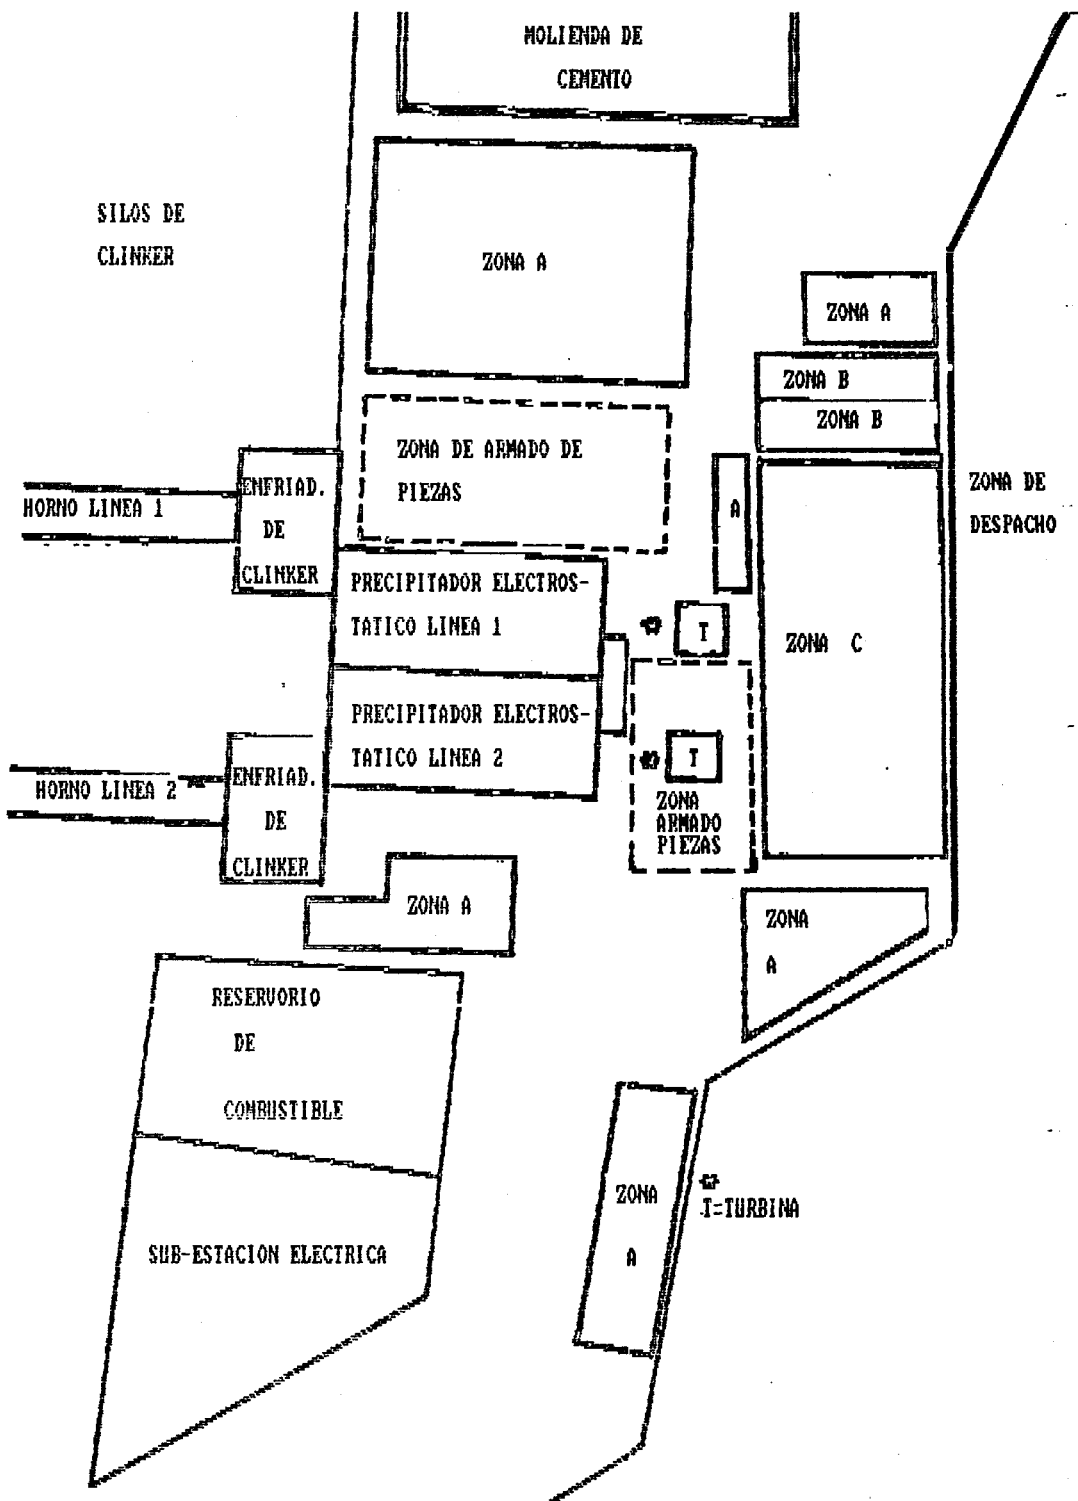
ESQUEMA DE PLANTA DE LAS ZONAS DE ALMACENAJE Y ARMADO
